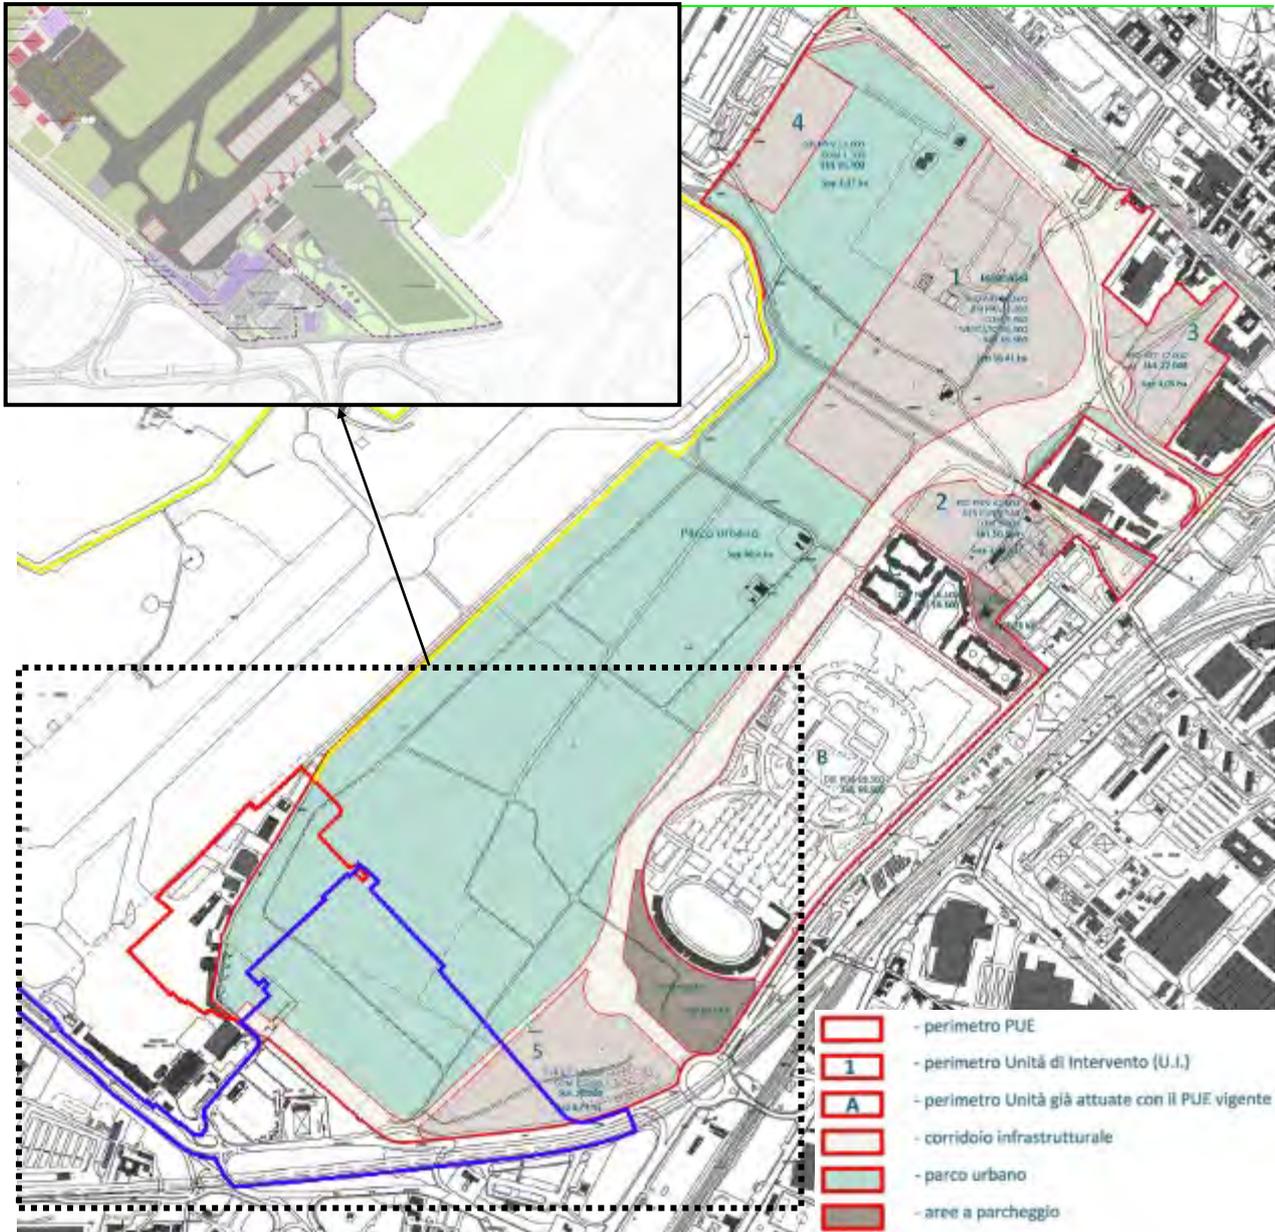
Sovrapposizione planimetrica tra le previsioni di Masterplan aeroportuale e le previsioni del PUE di Castello
